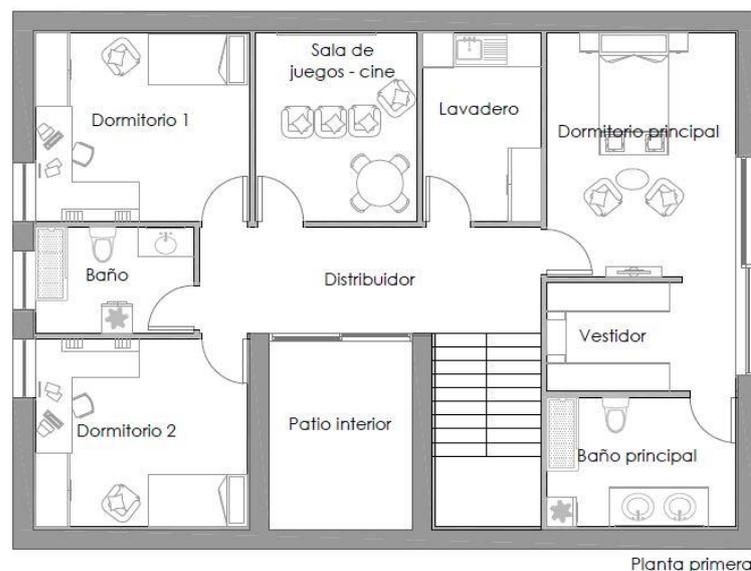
Distribución planta primera. Fuente: Elaboración propia.
